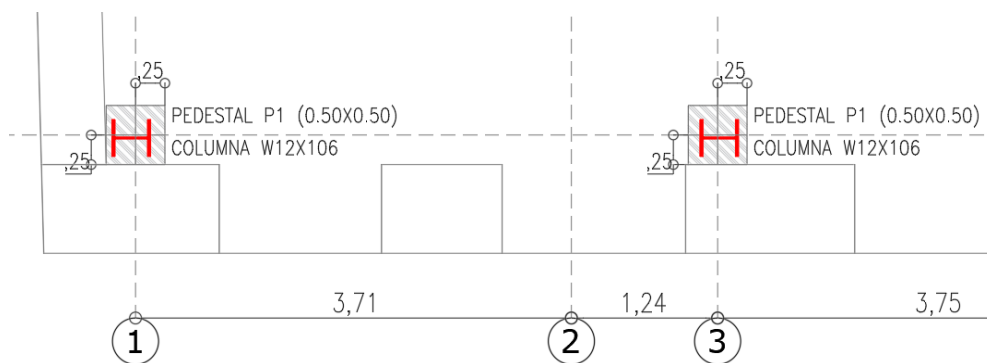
Detalle de disposicio de refuerzo frente al muro en piedra. Fuente. Alvaro Caballero
